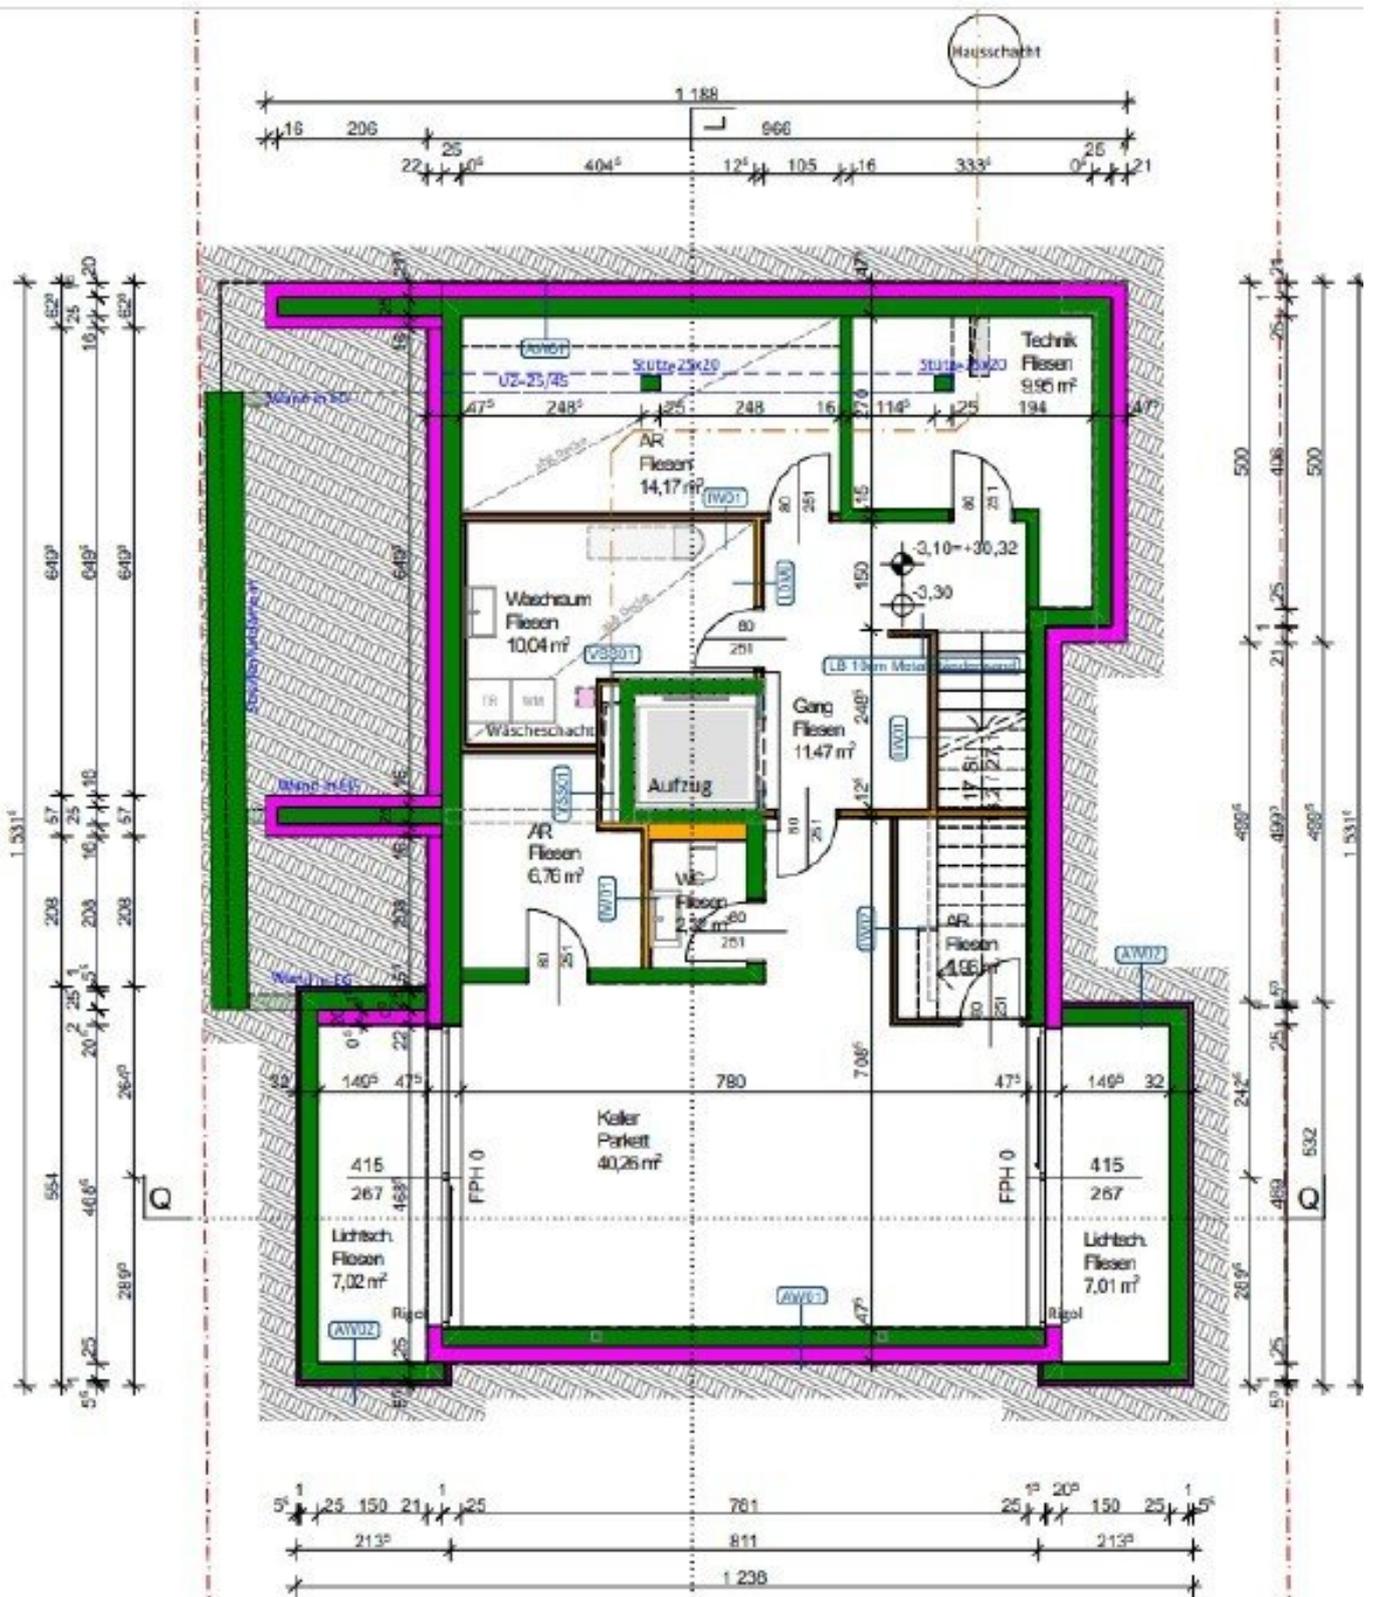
Grundrissplan Kellergeschoß | Einreichplan Einfamilienhaus | 16.06.2021
